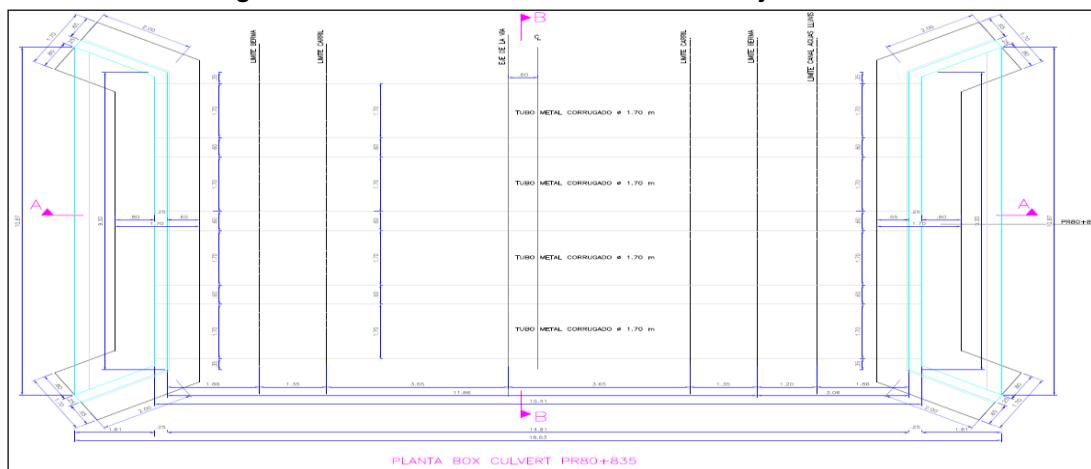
Figura 19. Vista frontal planos de diseño de la obra de drenaje PR80+835
